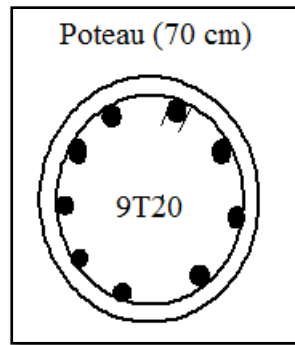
Ferrailage du poteau circulaire du bloc A2.
